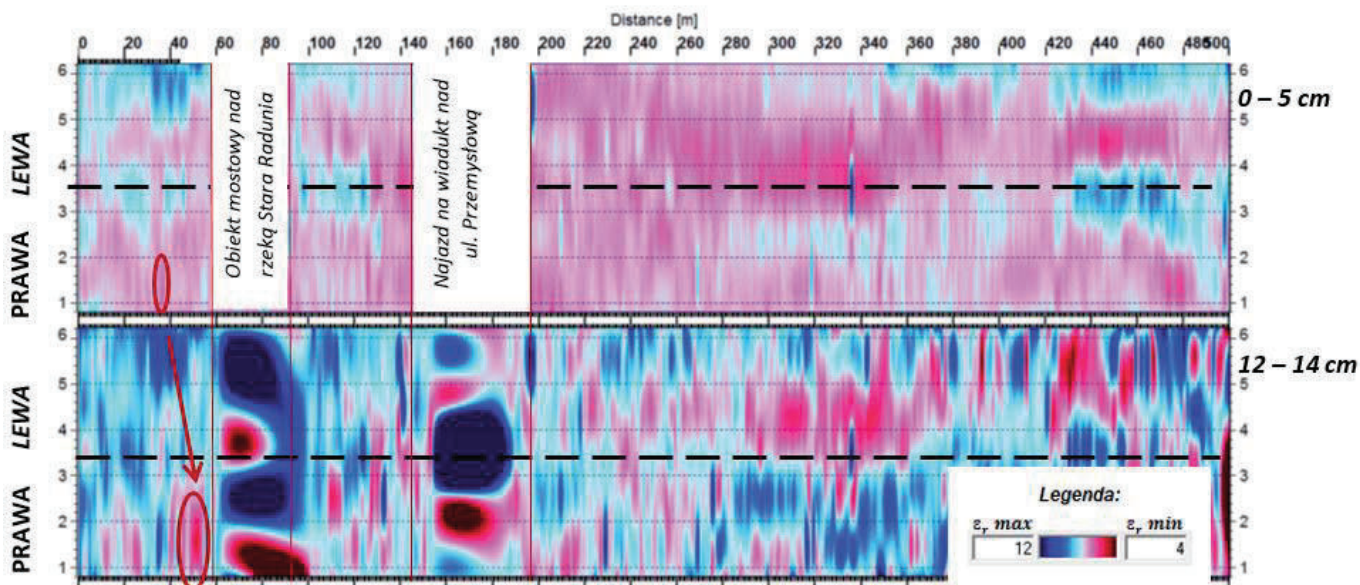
Uszkodzenia propagujące w głąb konstrukcji przy lewej krawędzi jezdni
